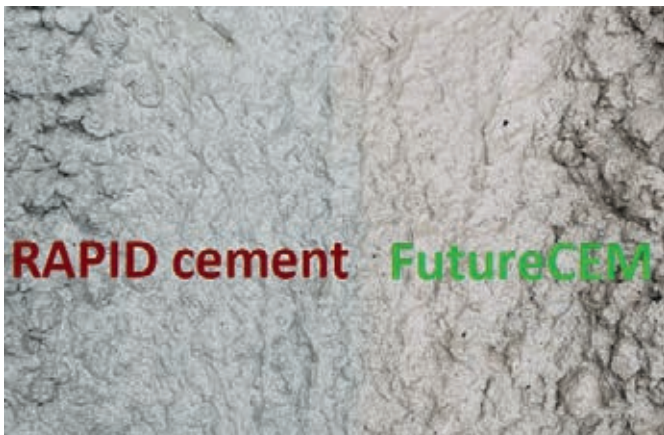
Farve af beton med RAPID cement kontra beton med FutureCEM.
